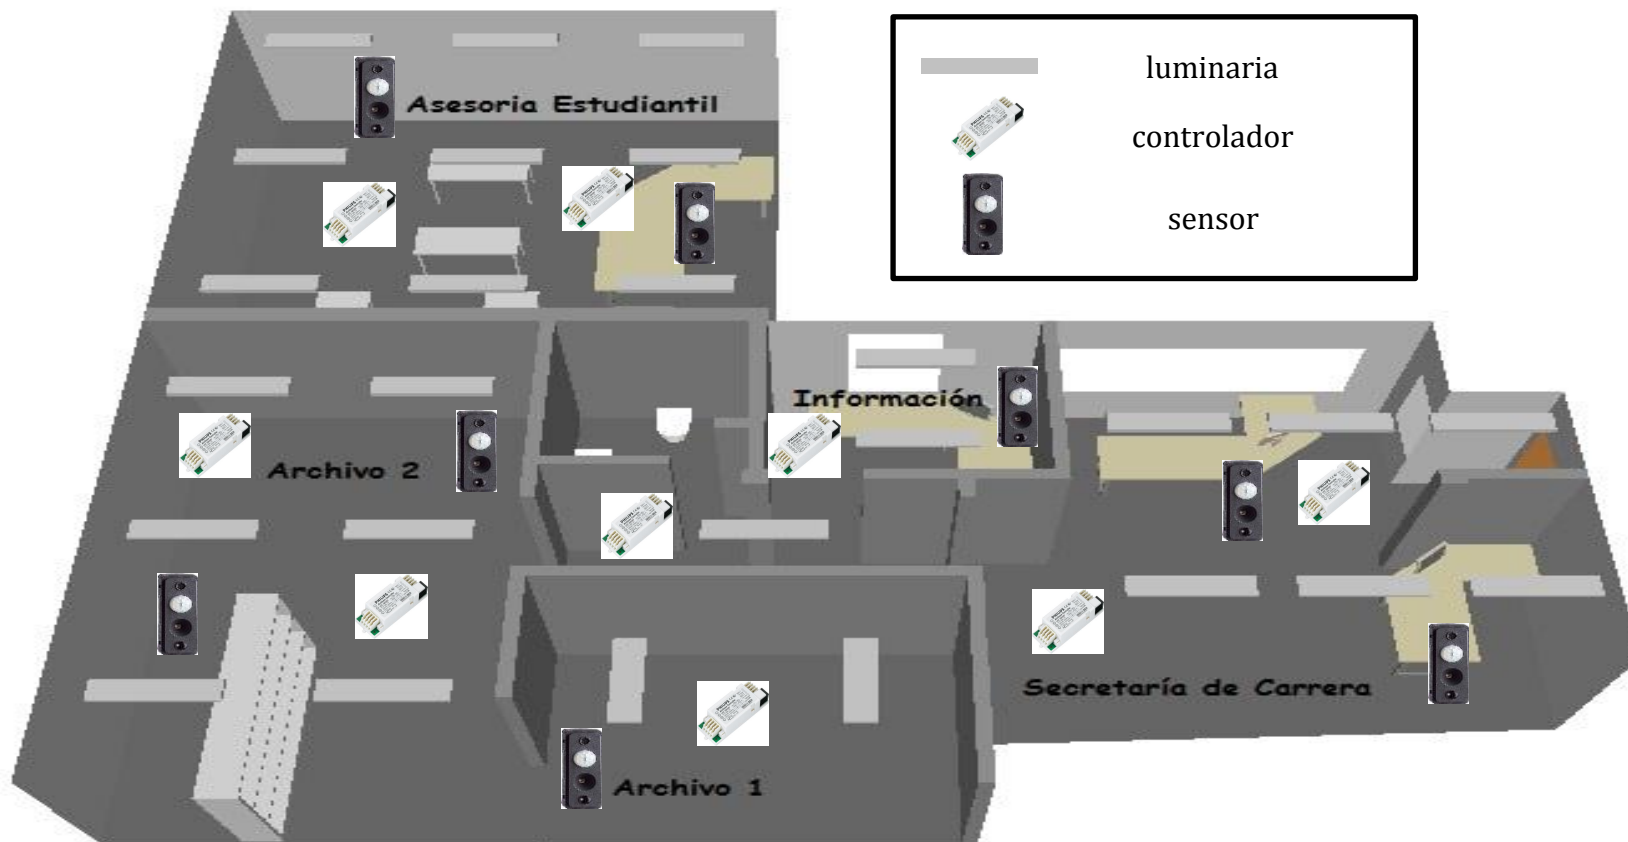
Plano tipo Y Distribución de los equipos planta baja A
